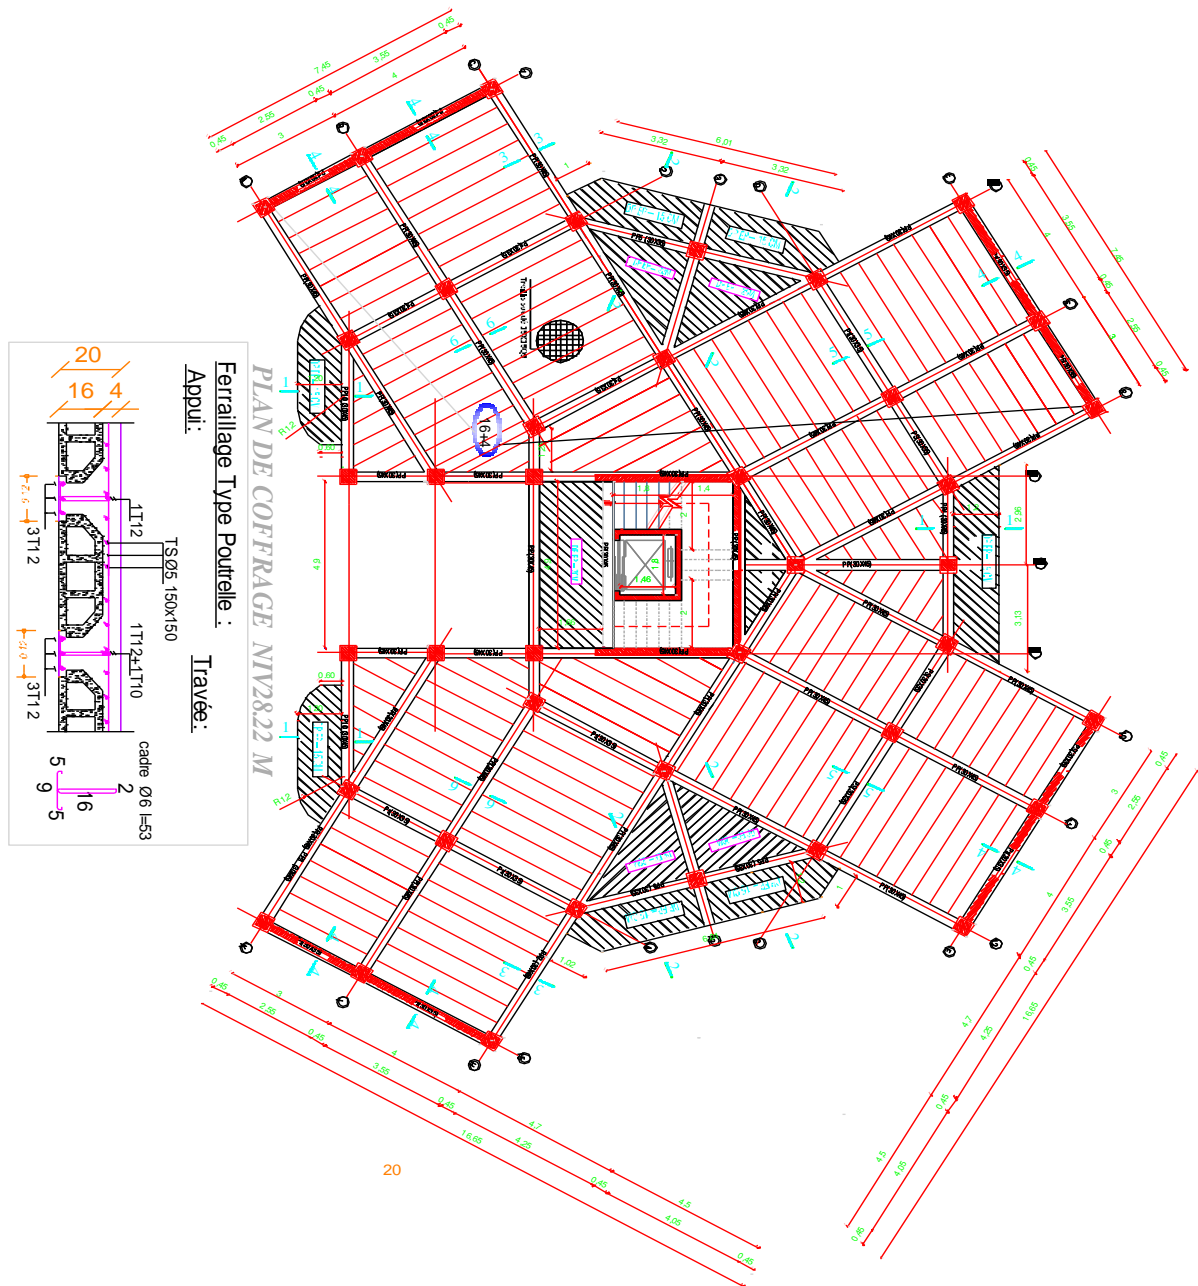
Coffrage Et Ferraillage De Plancher terrasse
